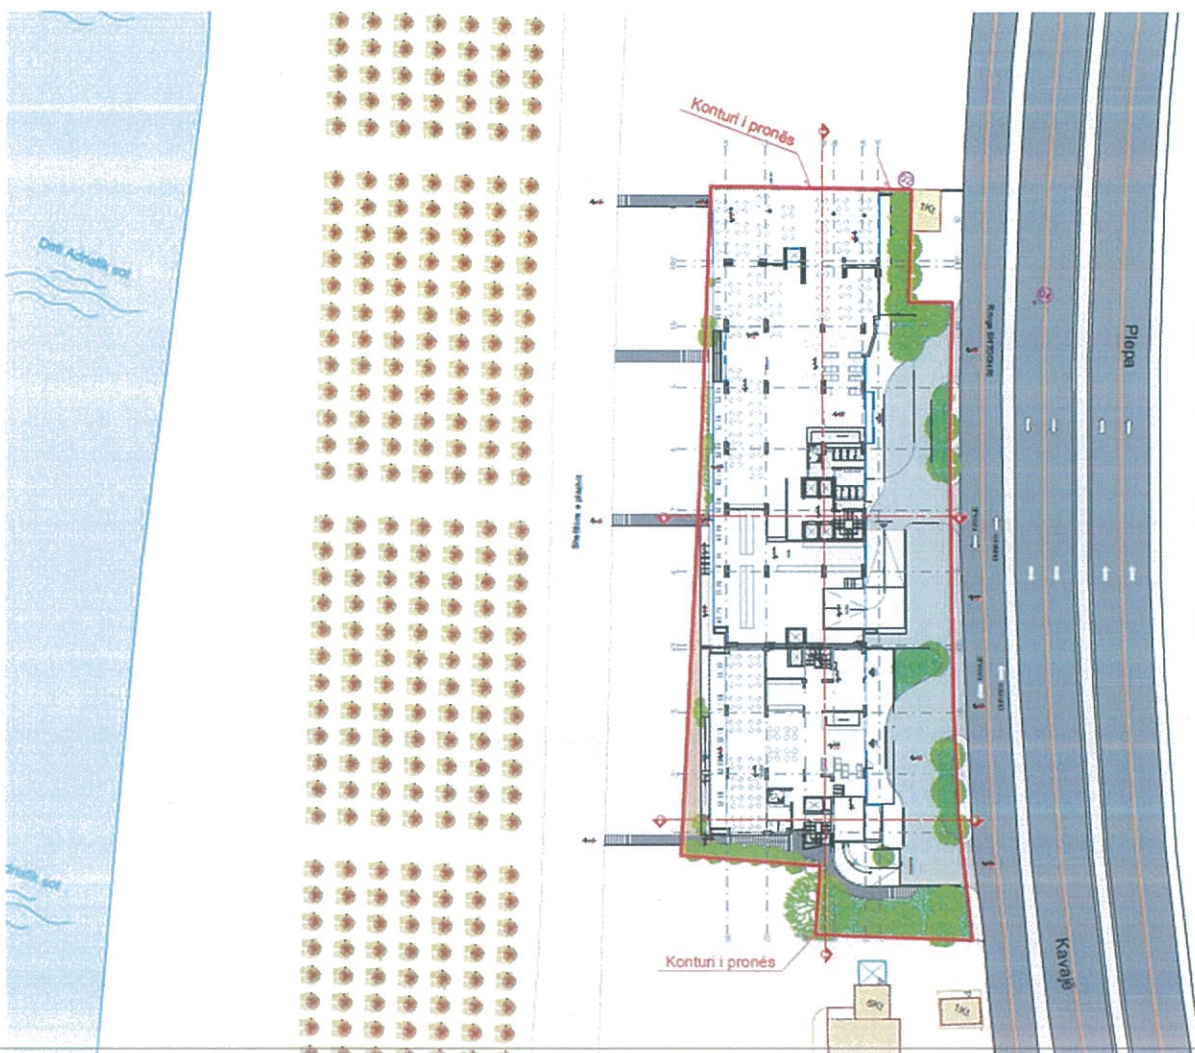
Plani i hapësirave të jashtme të objektit të propozuar
